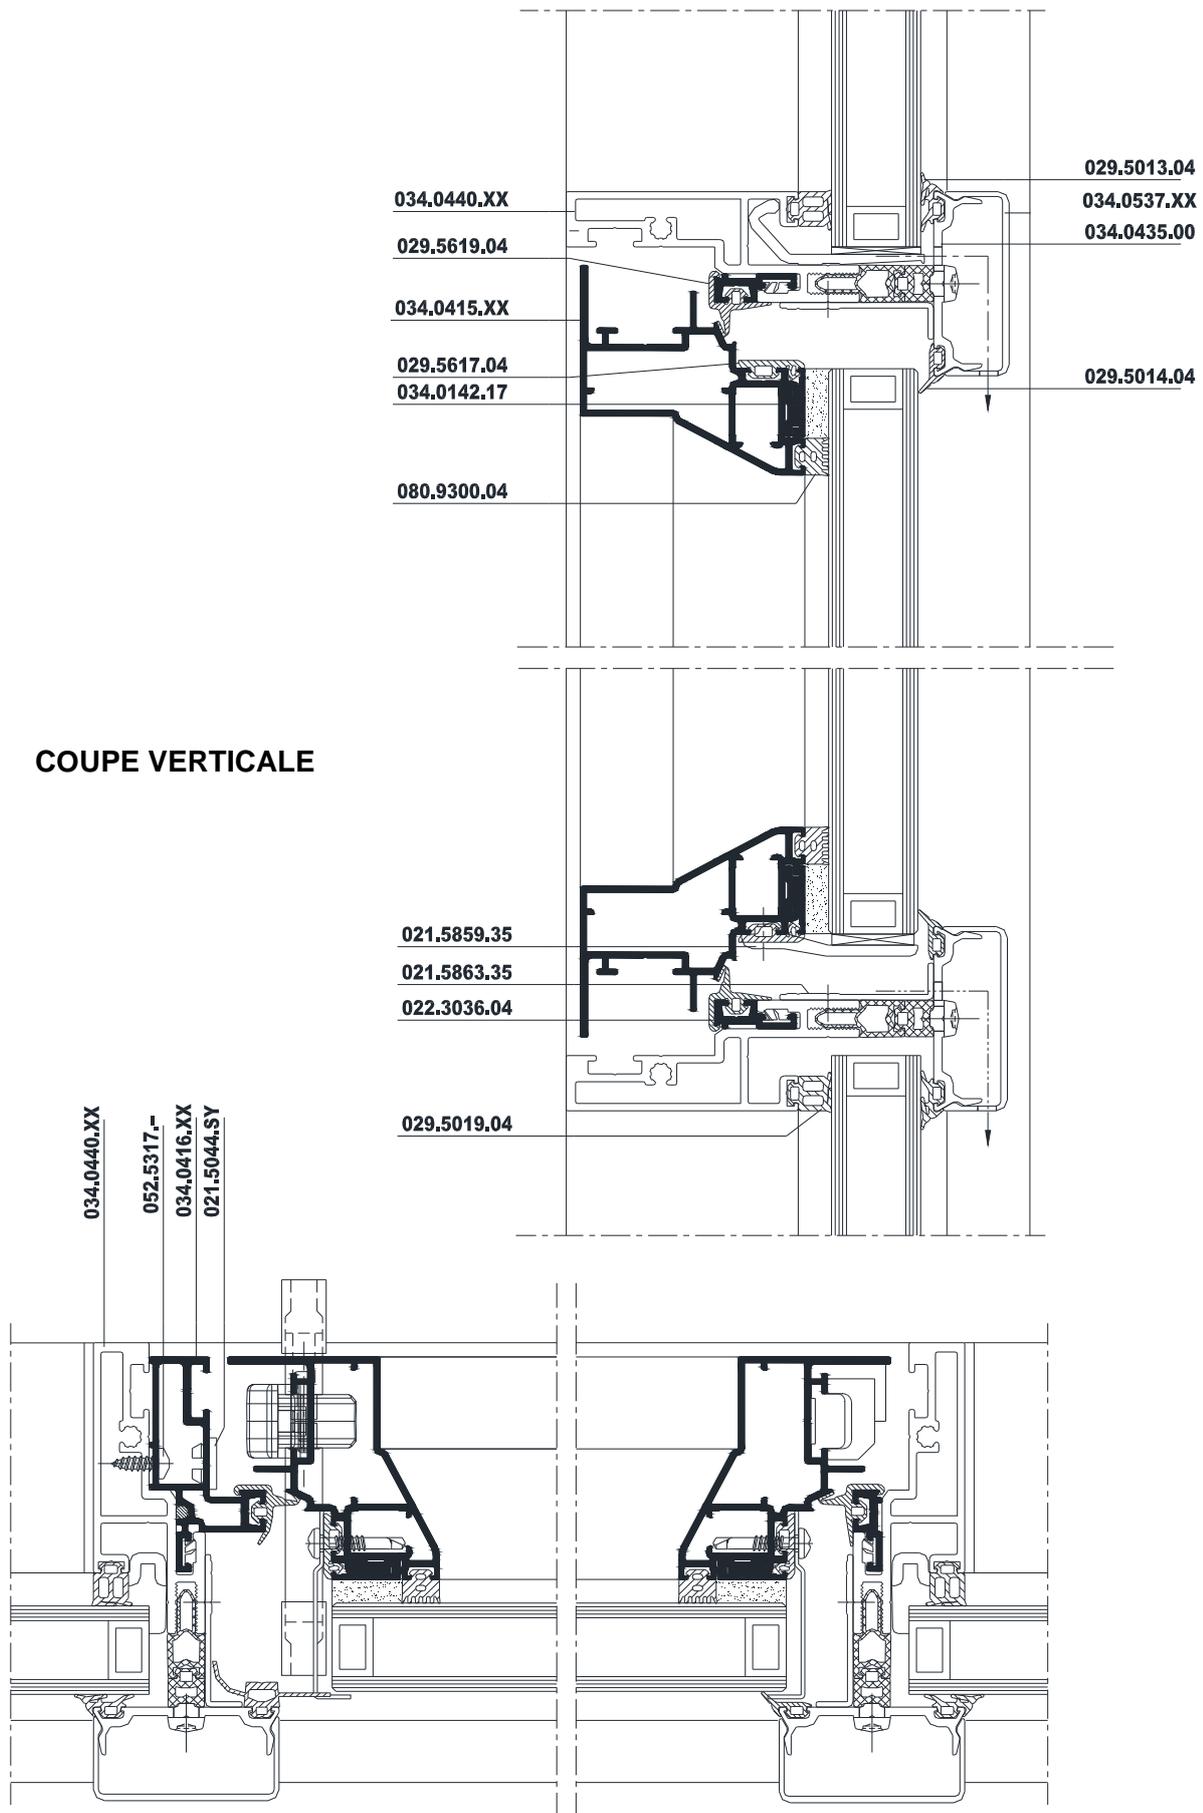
Ouvrant à la française d'accès pompier dans grille
